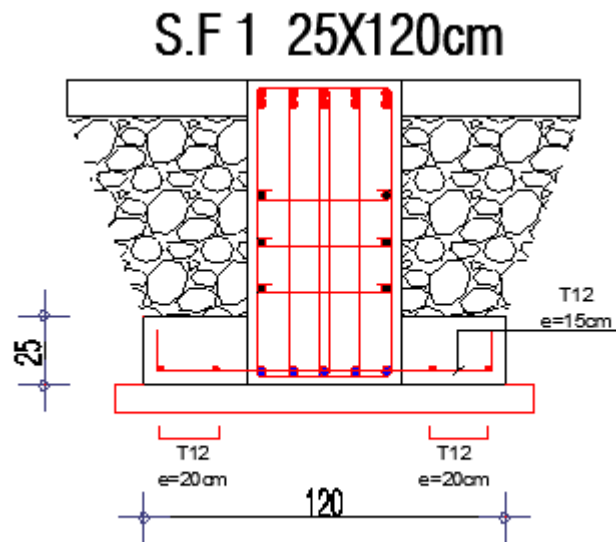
Schéma de ferrailage semelle filent 25X120
